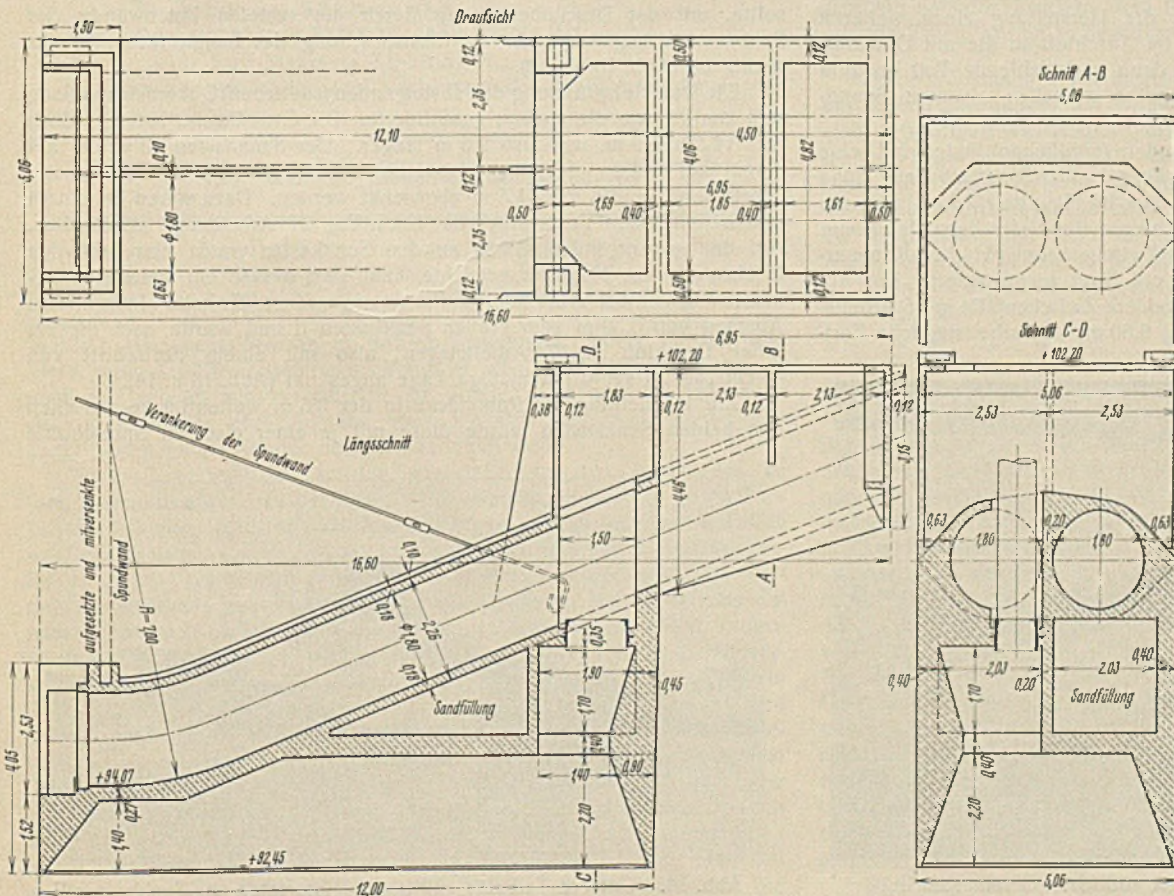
Senkkasten I mit ausgekragtem Brunnen.
